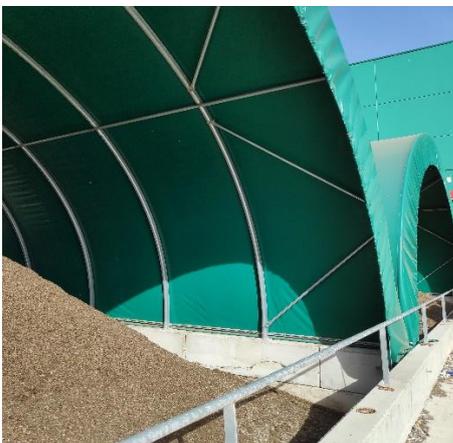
Detalle estructura cobertizo(PA) Imagen 7. Vista trasera zona de maduración (PA)
